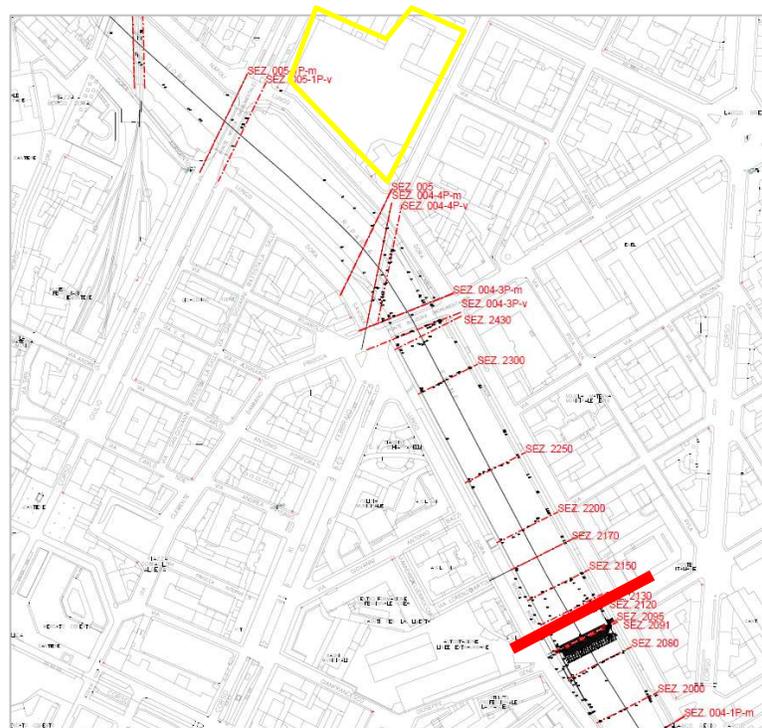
Sovrapposizione area stralcio di parte delle sezioni modellate e localizzazione traversa oggetto di intervento (rosso) - area di progetto TSH (giallo) – distanza circa 500 metri
